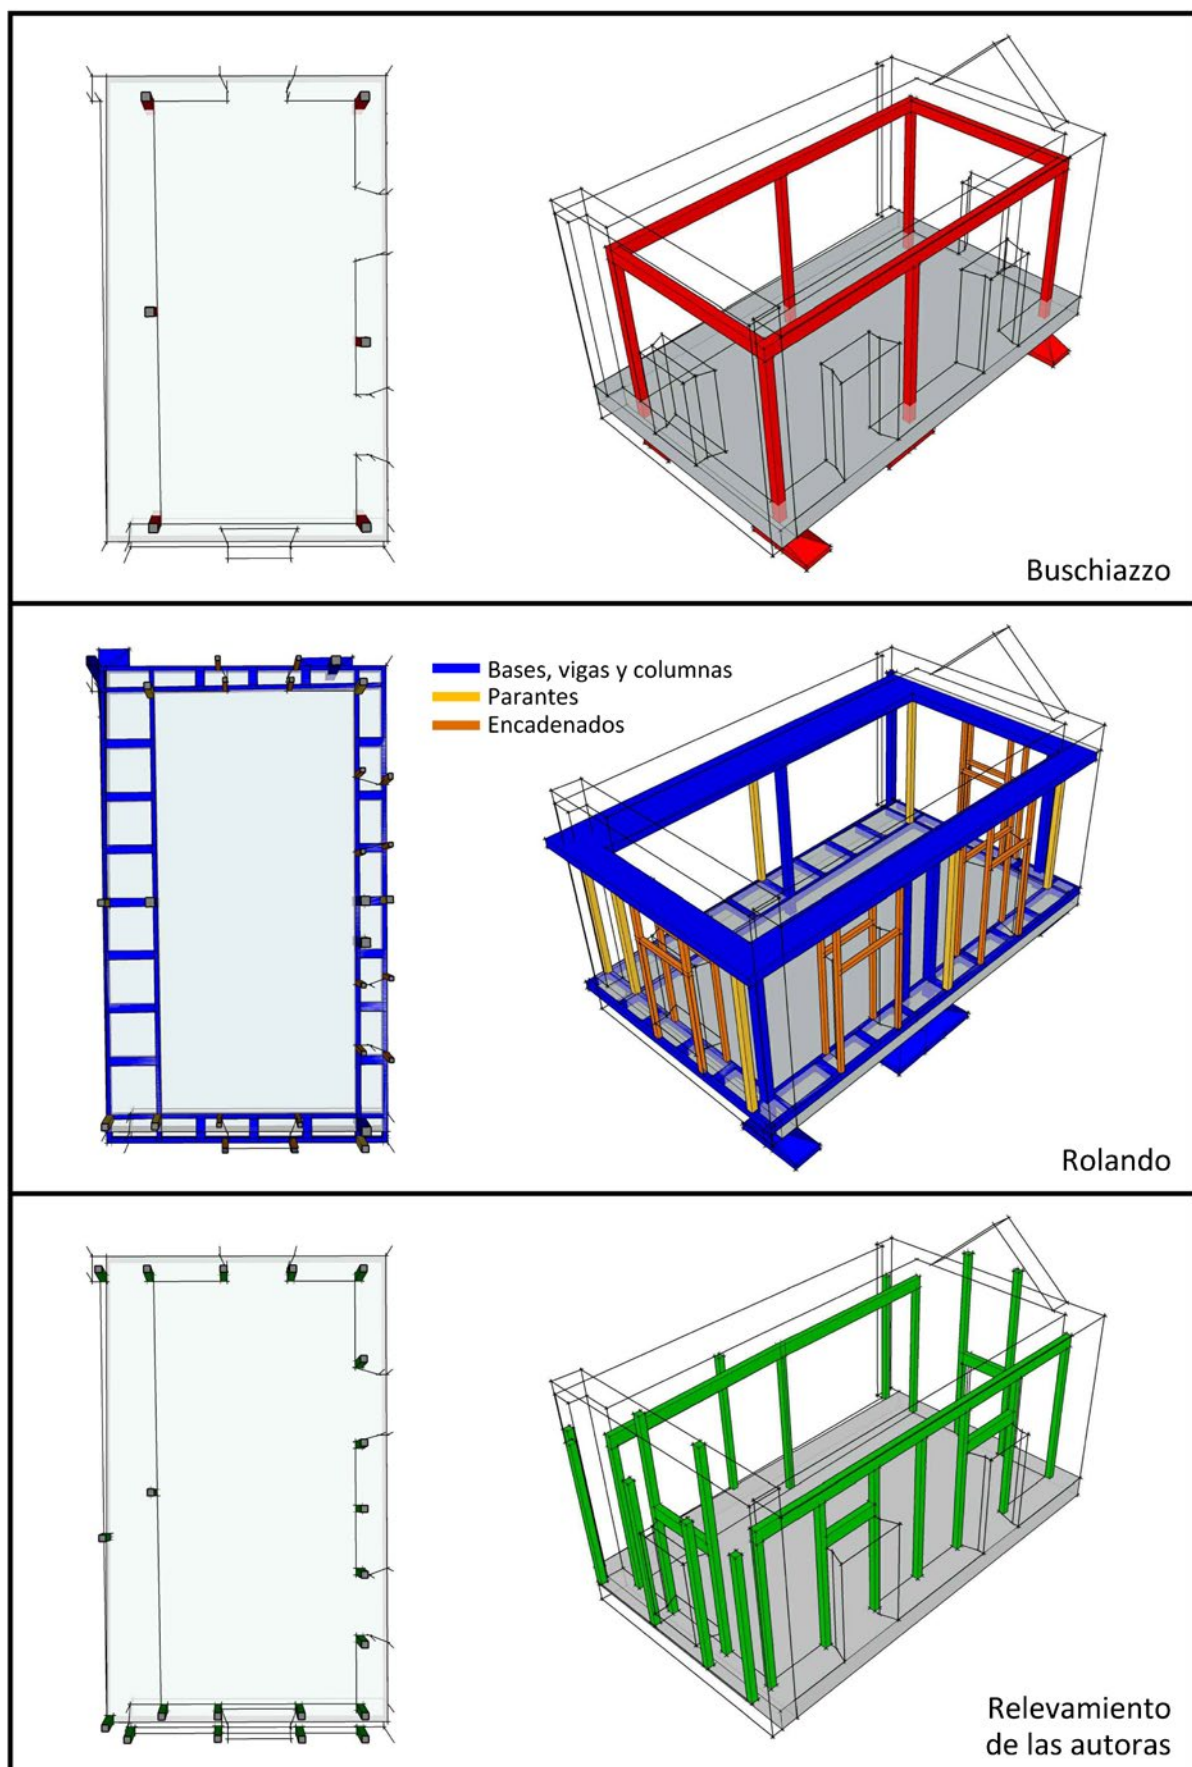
Reconstrucción en planta y perspectiva de las propuestas de intervención de Buschiazzo (arriba), Rolando (medio), y la estructura detectada con la cámara infrarroja (abajo). Fuente: elaboración propia.
